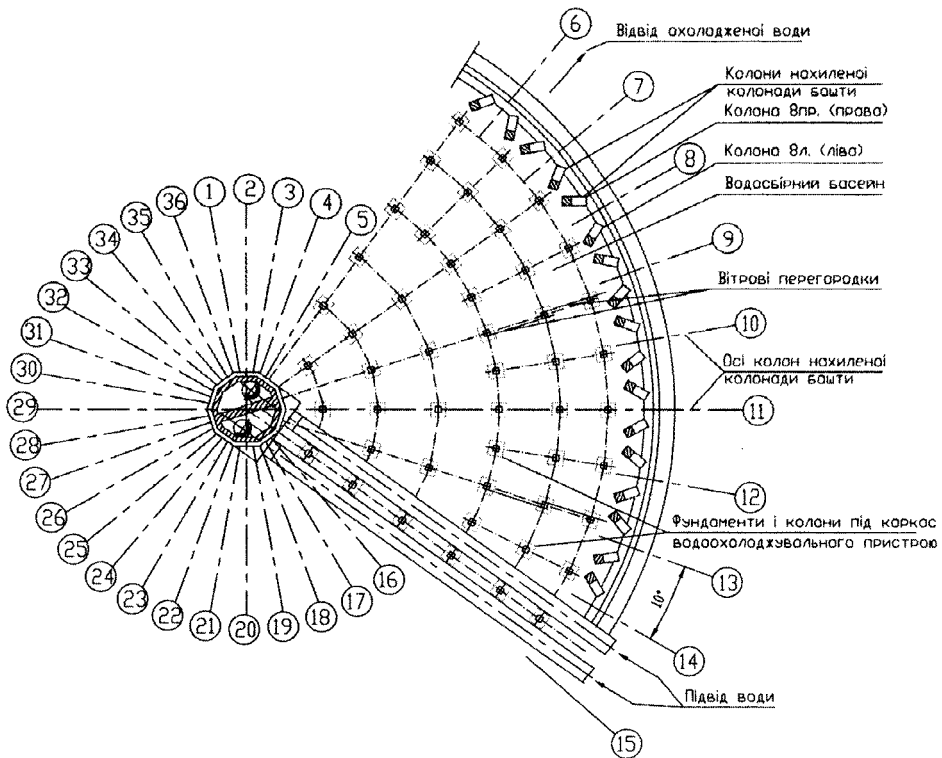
Фрагмент плану колон нахиленої колонади та фундаментів під каркас водоохолоджувального пристрою
